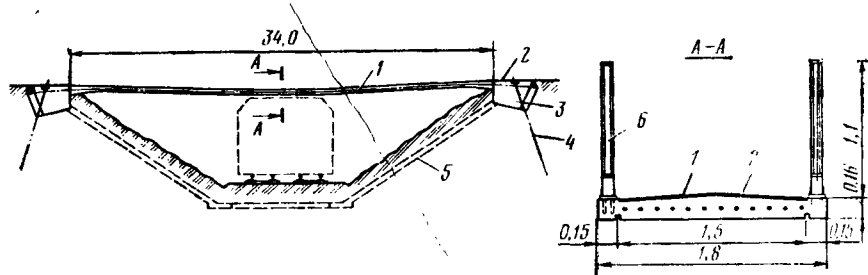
Конструкция железобетонного пешеходного моста в виде гибкой ленты:
